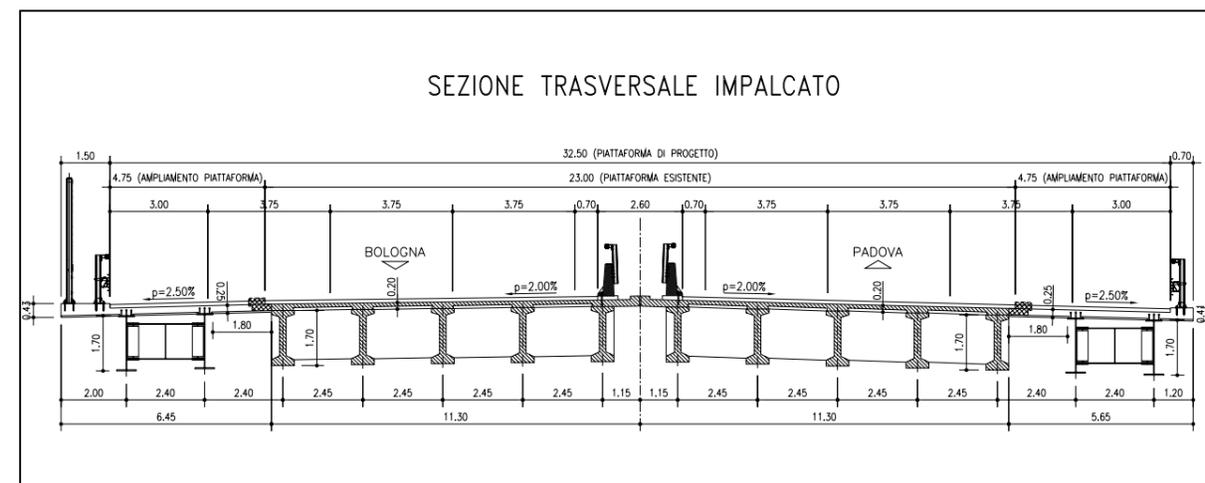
Sezione dell'impalcato e profilo del ponte sul canale Vigenzone
